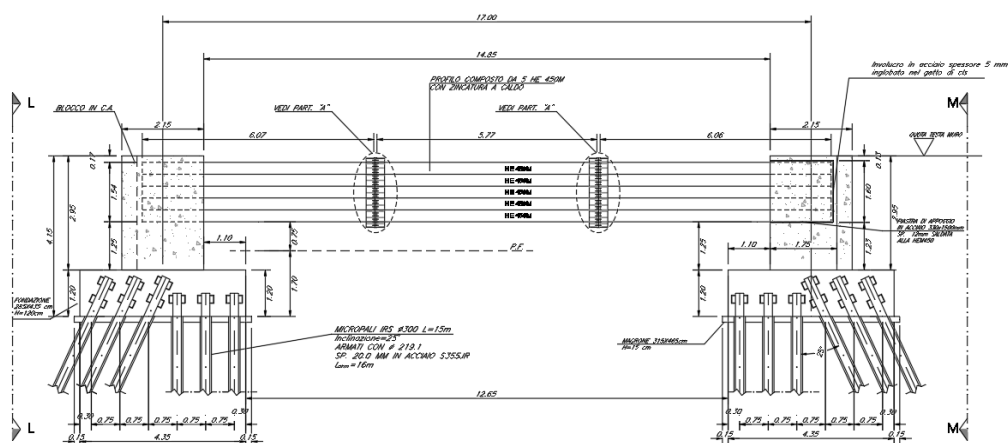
MU03 Prospetto generale muro opera di protezione con luce asse di 17.00 m.
